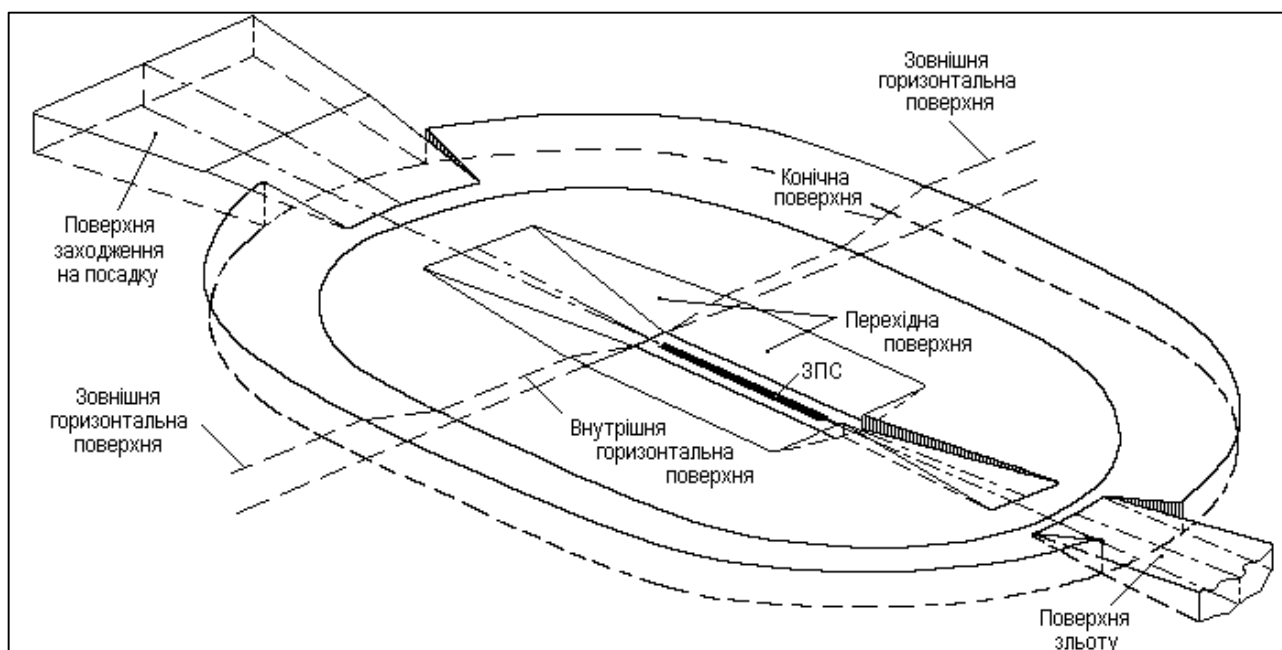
Розташування поверхонь обмеження перешкод для аеродромів з однією злітно-посадковою смугою
